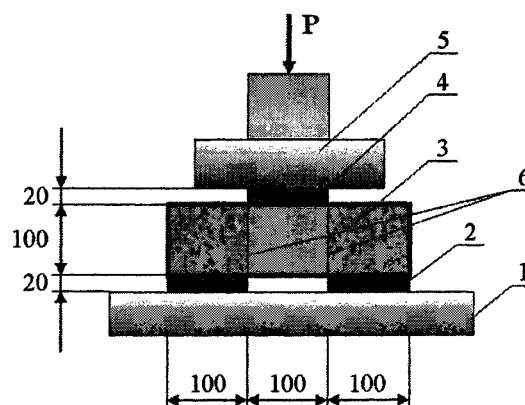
Схема проведения испытаний бетонной балочки на срез в зоне технологического шва: 1 – опорная площадка пресса П-10; 2 – металлические пластины размером $100 \times 100 \times 20$ мм, закрепленные к опорной площадке; 3 – испытываемый образец-балочка; 4 – металлическая пластина размером $100 \times 100 \times 20$ мм передающая нагрузку на среднюю часть образца; 5 – рабочий шток пресса создающий сжимающее усилие; 6 – плоскости среза
